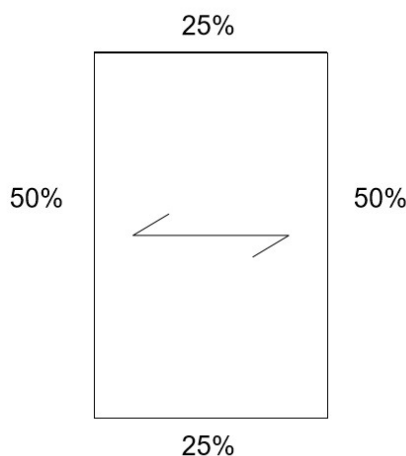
Carregamento: laje pré-fabricada e parede convencional
